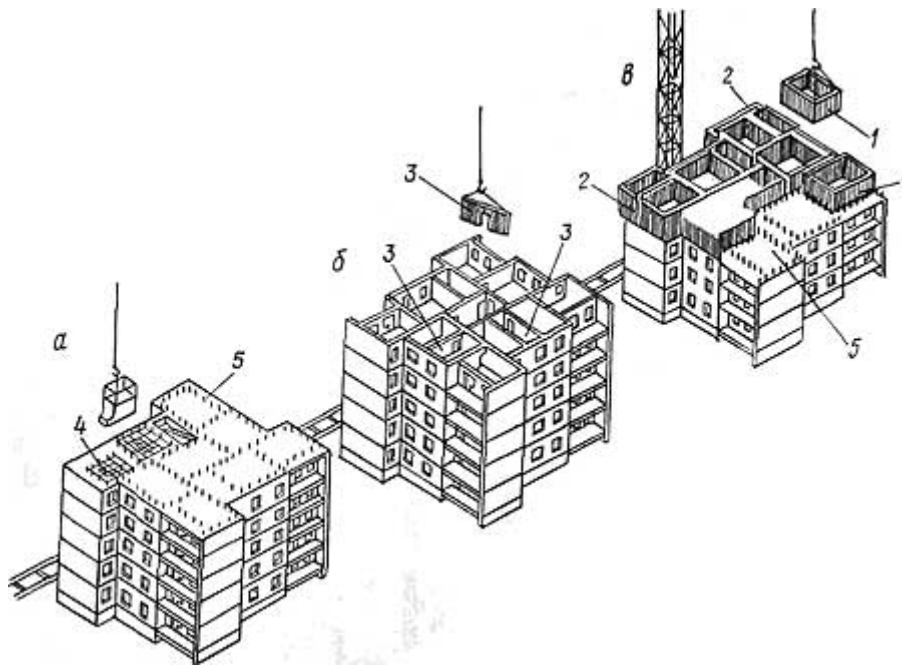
Строительство зданий из монолитного бетона с применением объемной вертикально извлекаемой опалубки:
